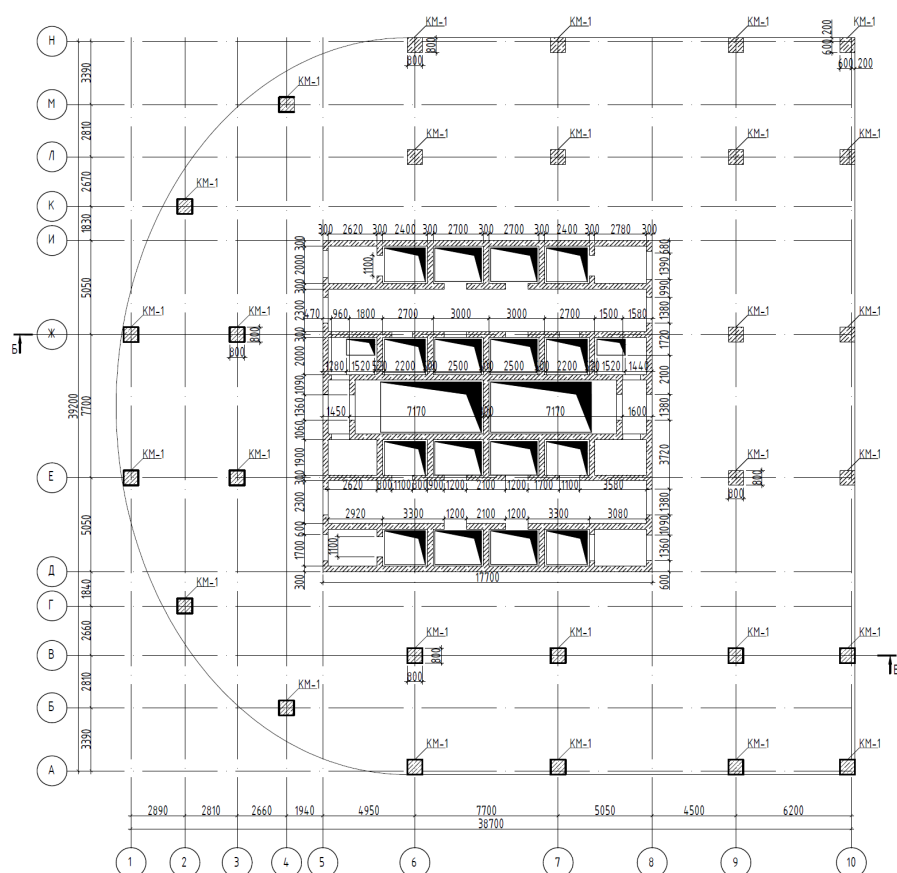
Схема расположения несущих элементов железобетонного каркаса здания
